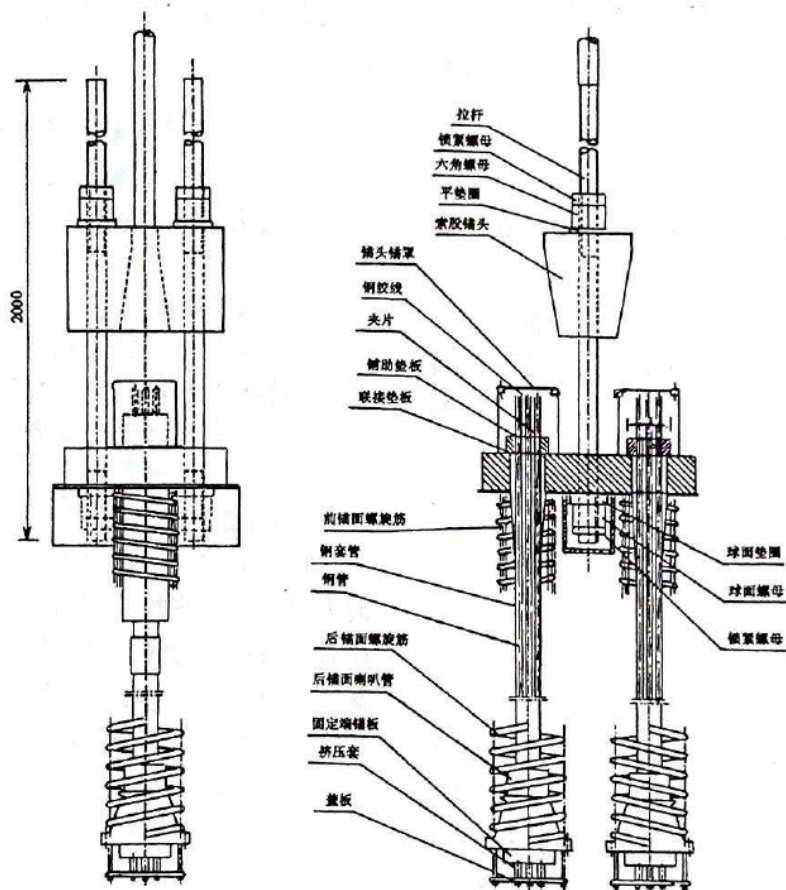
MD15-7 预应力锚固系统构造(尺寸单位:mm)
